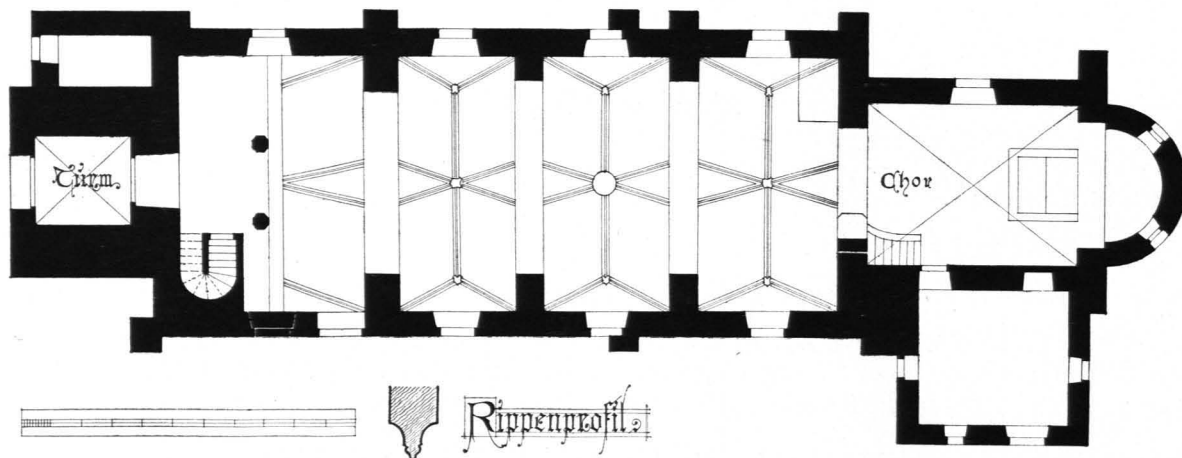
Neu-Pölla, Pfarrkirche, Grundriß 1 : 250 (S. 170)
